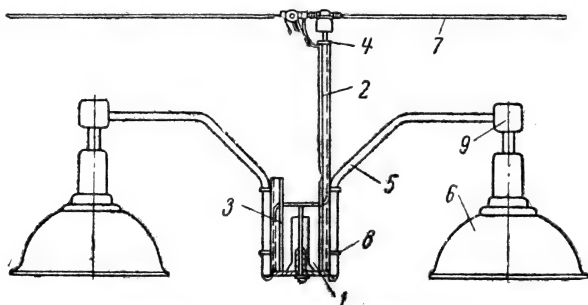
Крепление светильников и проводки на изоляторах к нижнему поясу металлической фермы.
